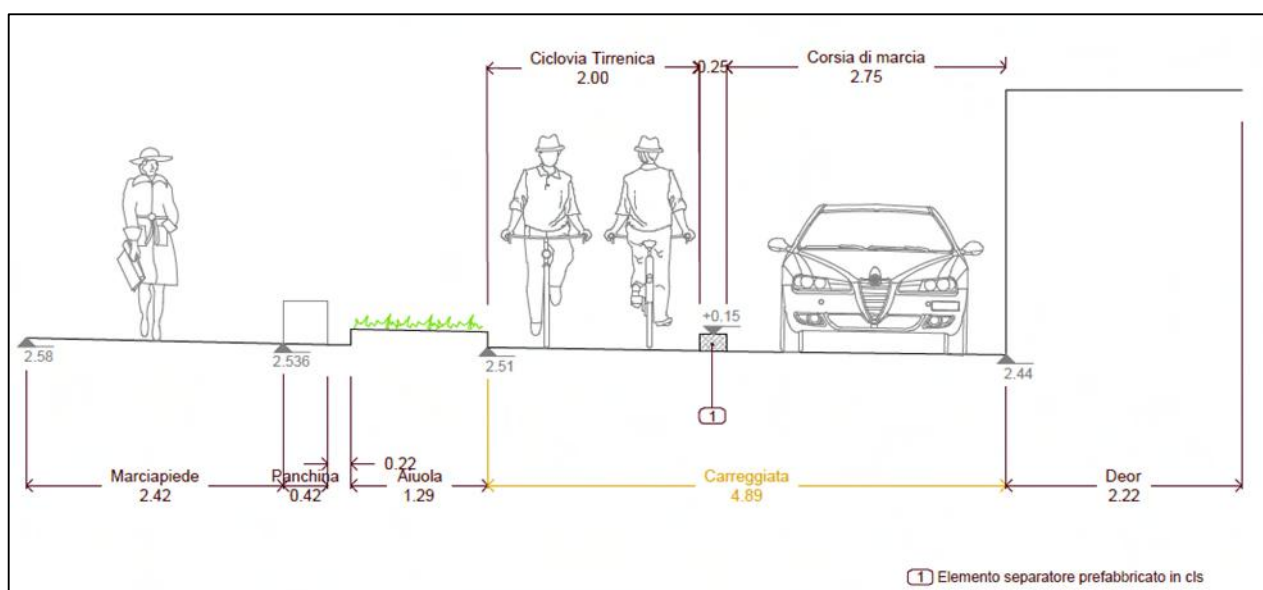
Sezione 05 di progetto trasversale su Viale Carducci
